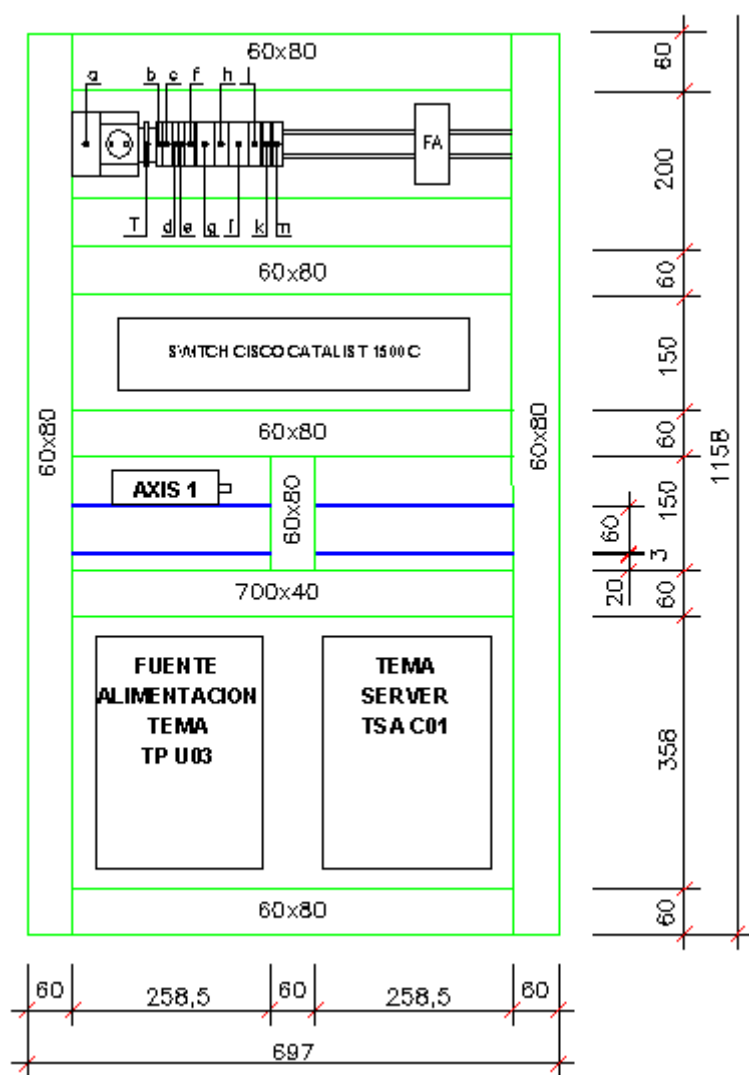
Diseño cuadro eléctrico de la zona este sur planta baja
